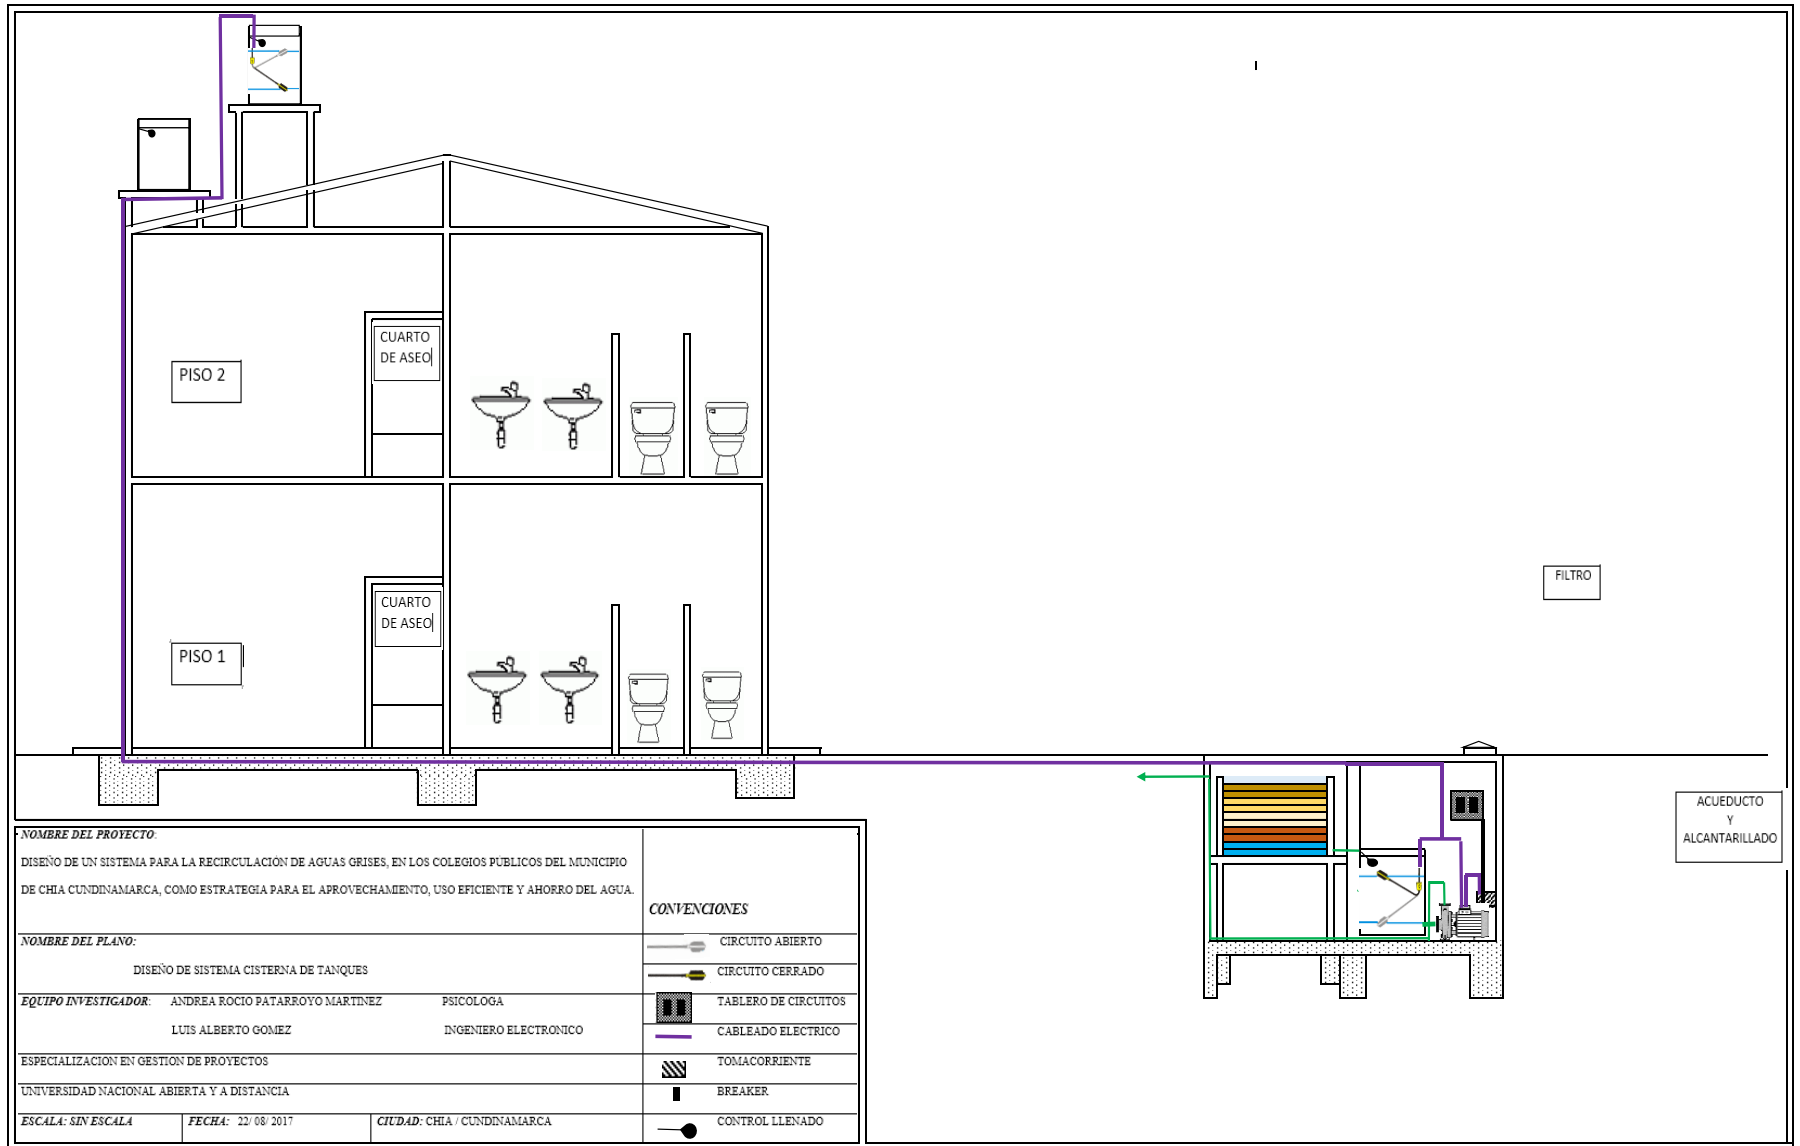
Plano de Diseño Arquitectónico de Fontanería
